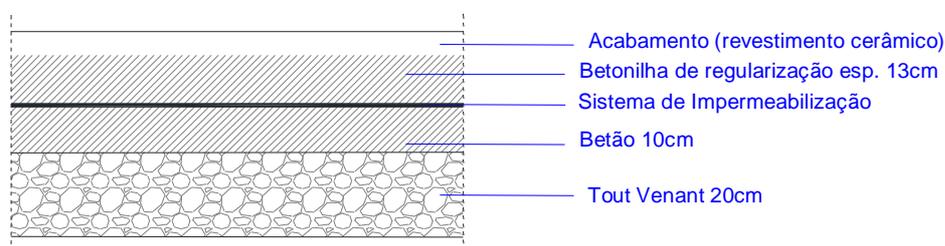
Pormenor de pavimento térreo (cedida pela empresa)
